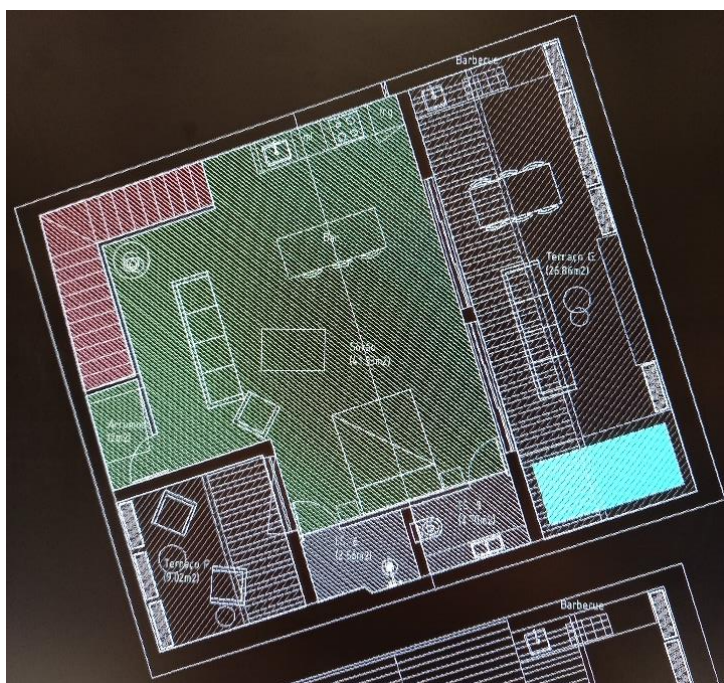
Planta de pavimentos_Sótão. Fonte: Atelier Studio Arte.
